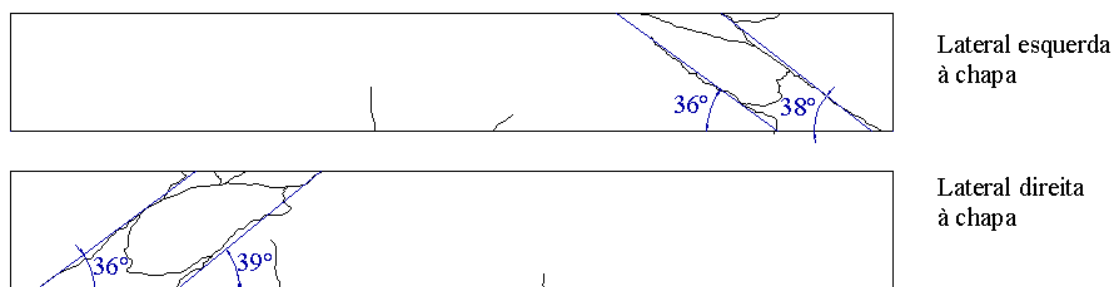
Fissuração na viga V3 e inclinações das fendas
